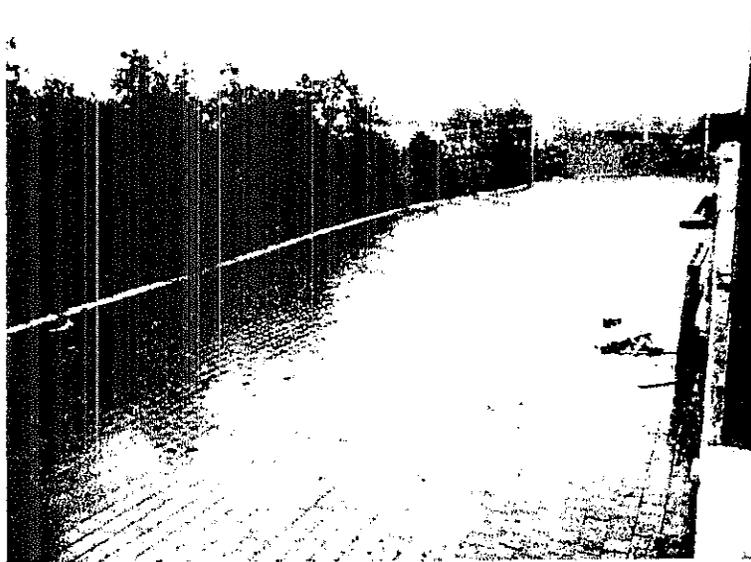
INGRESO TERMINADO CANAL RECOLECTOR DE AGUAS Y LINDERO ORIGINAL CON LA CALLE
